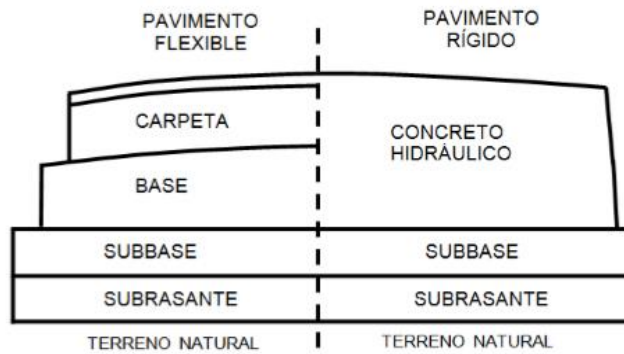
Estructuración común de los pavimentos (SCT, Catálogo de secciones estructurales de pavimento para las carreteras de la República Mexicana, 2013).
